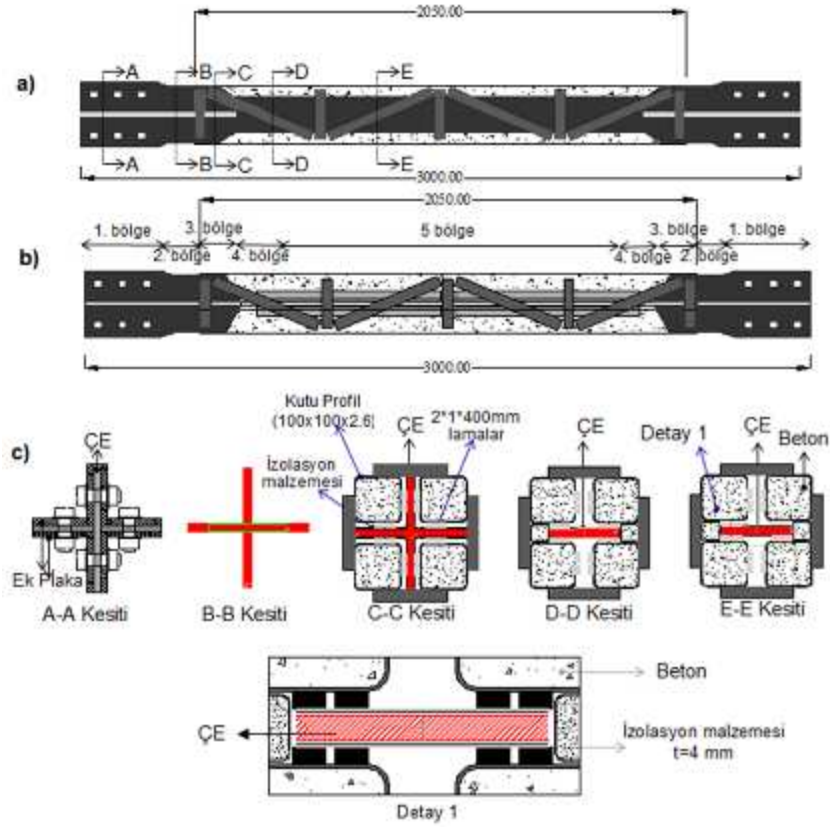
1. BEÇÇ\_2 elemanı detay çizimleri
